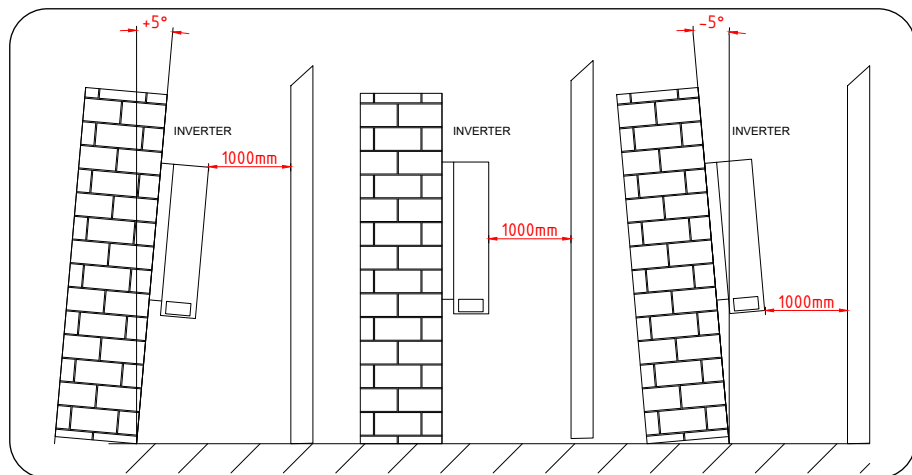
Spazio di installazione dell'inverter (distanze minime), vista laterale
